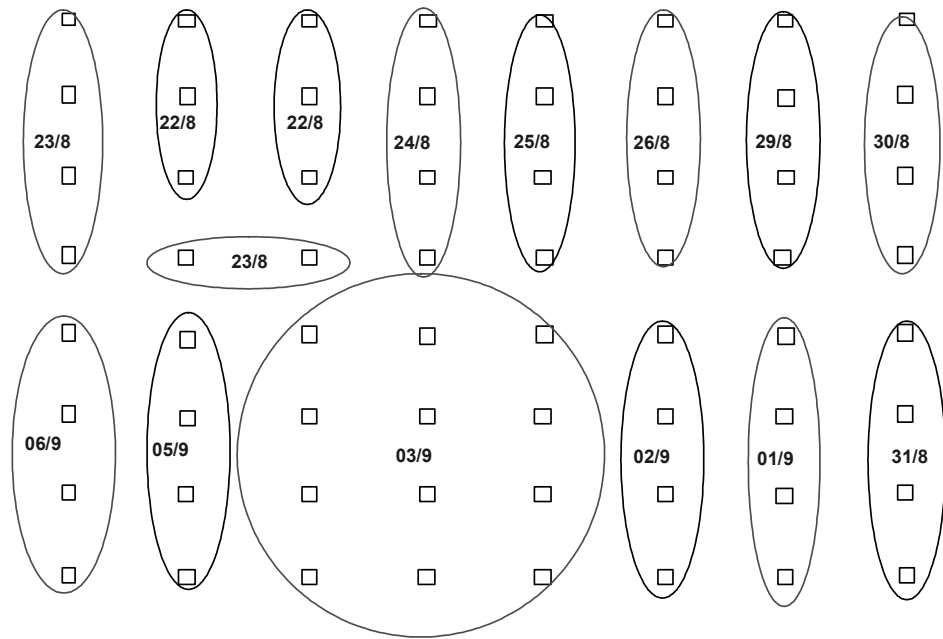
Plano de seqüenciamento da montagem dos pilares – Etapa 1
